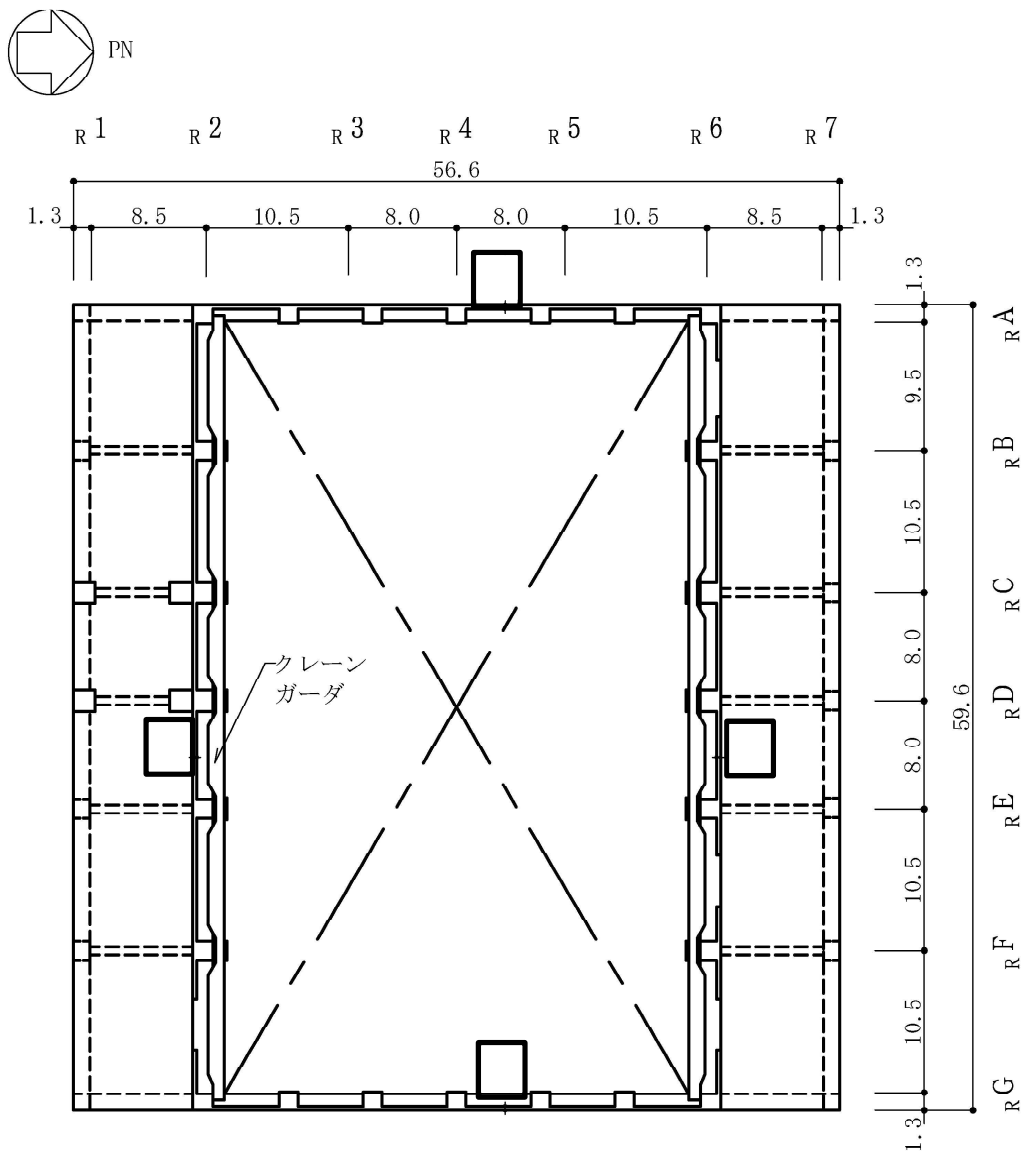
原子炉建屋の概略平面図 (CRF, T. M. S. L. 38.2m) (8/9) (単位 : m)
